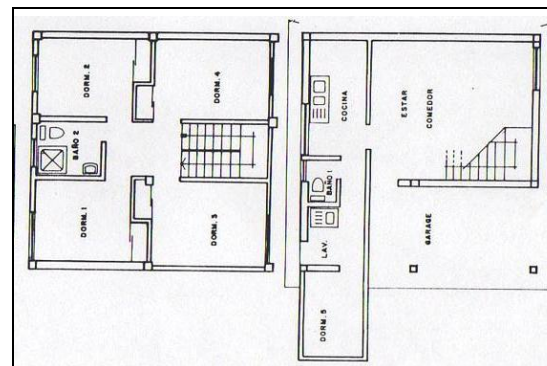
h. Vivienda LV-4. Plantas Baja y Alta
